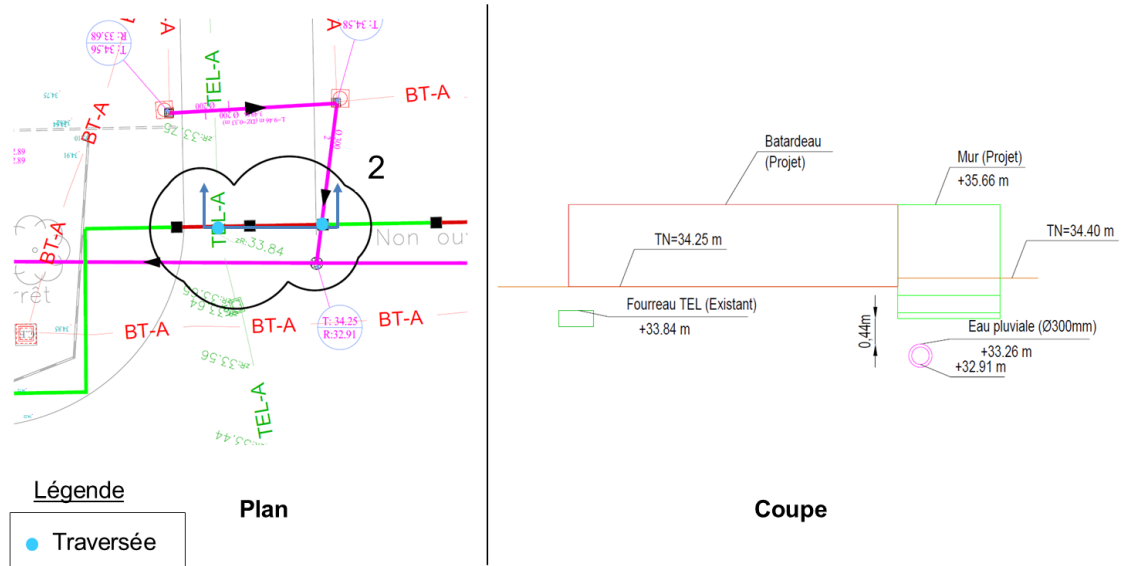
Batardeau traversant un fourreau Télécom et un mur traversant une conduite EP
